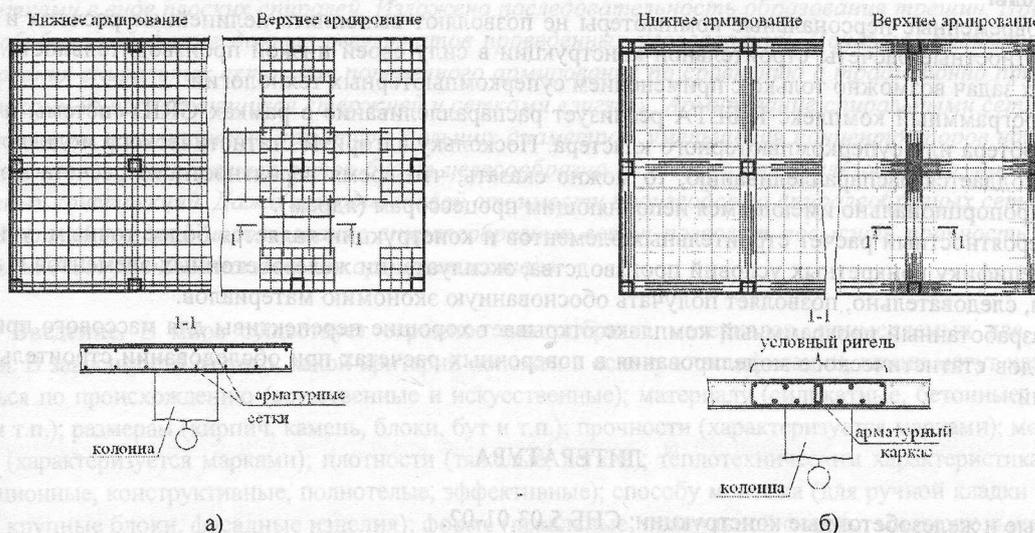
Традиционная схема армирования плоских монолитных плит перекрытия (а); концентрированное «ригельное» армирование плоских плит пространственными каркасами (б)
